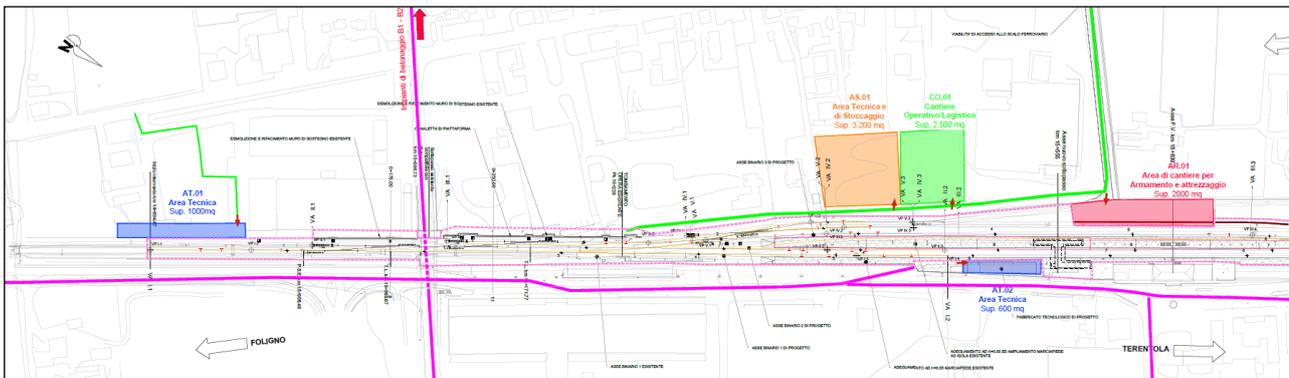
Planimetrie dei cantieri e viabilità di accesso alle aree di cantiere (in verde pista di cantiere)
